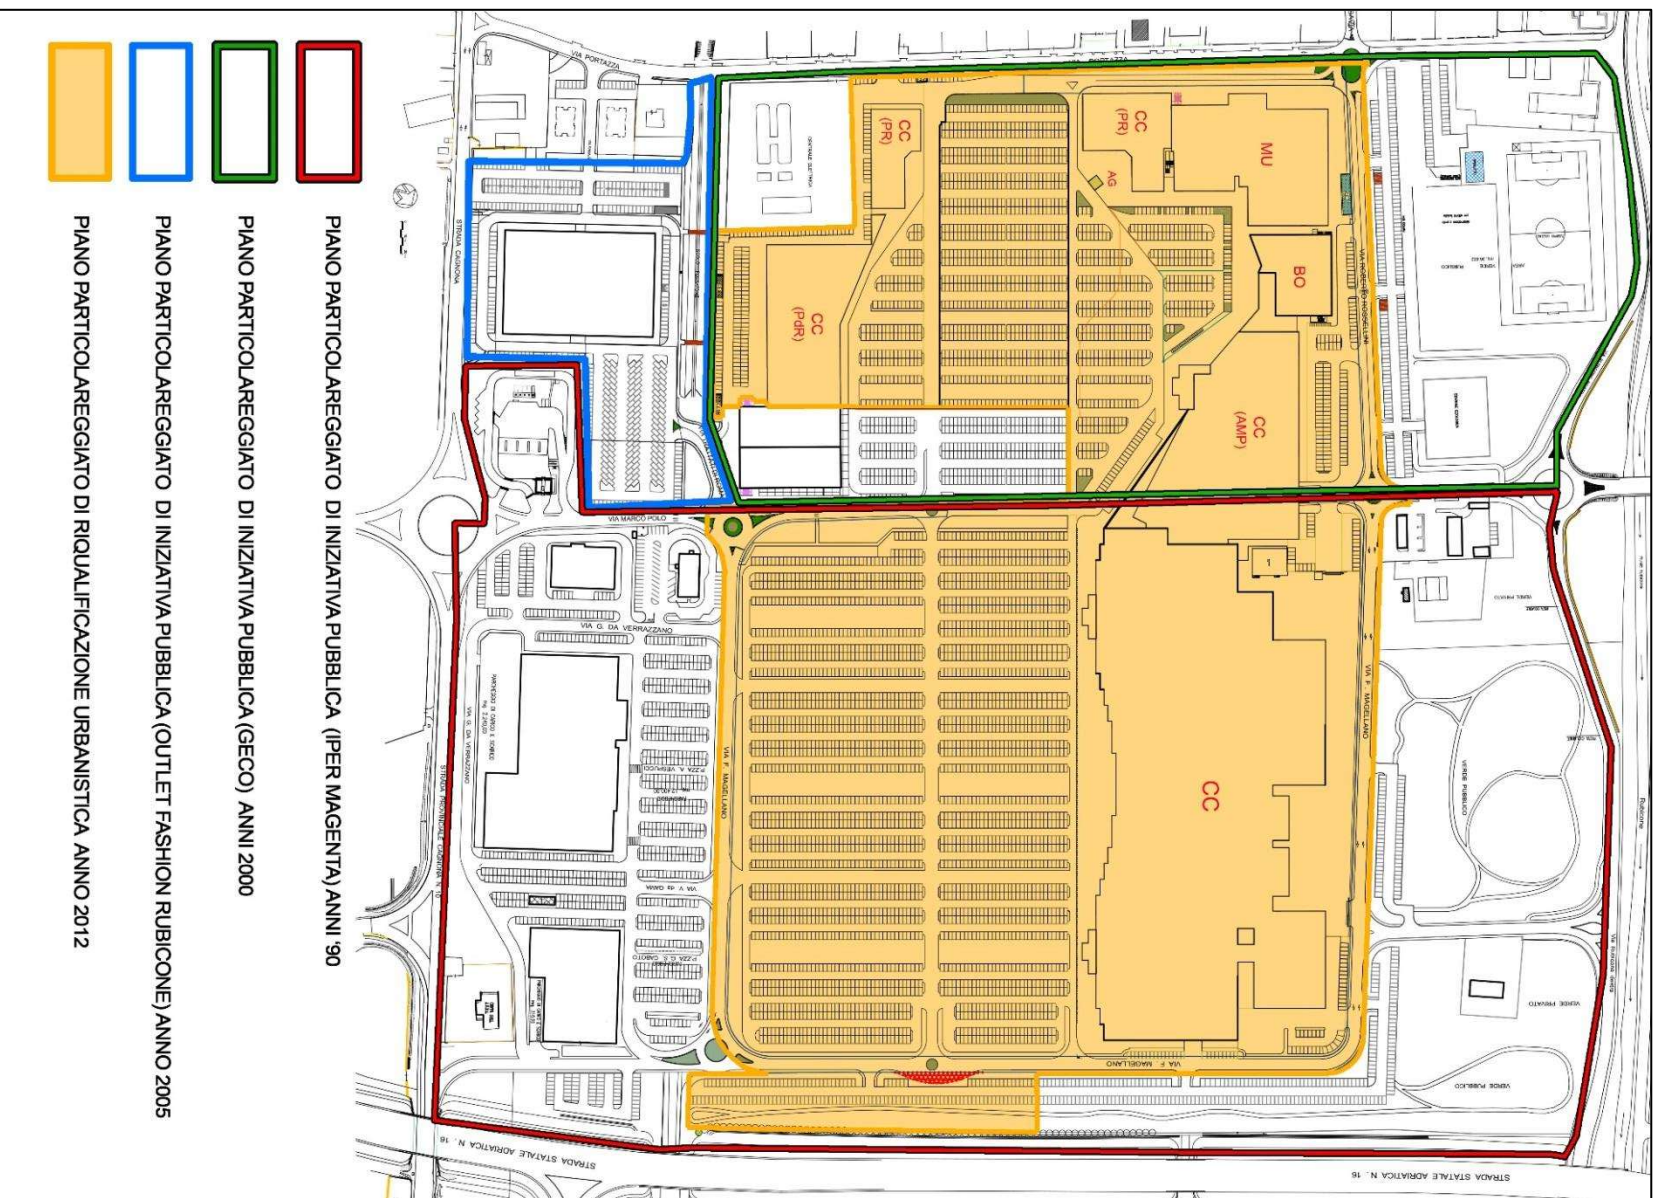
planimetria del Polo Funzionale con individuazione dei Piani Particolareggiati eseguiti
